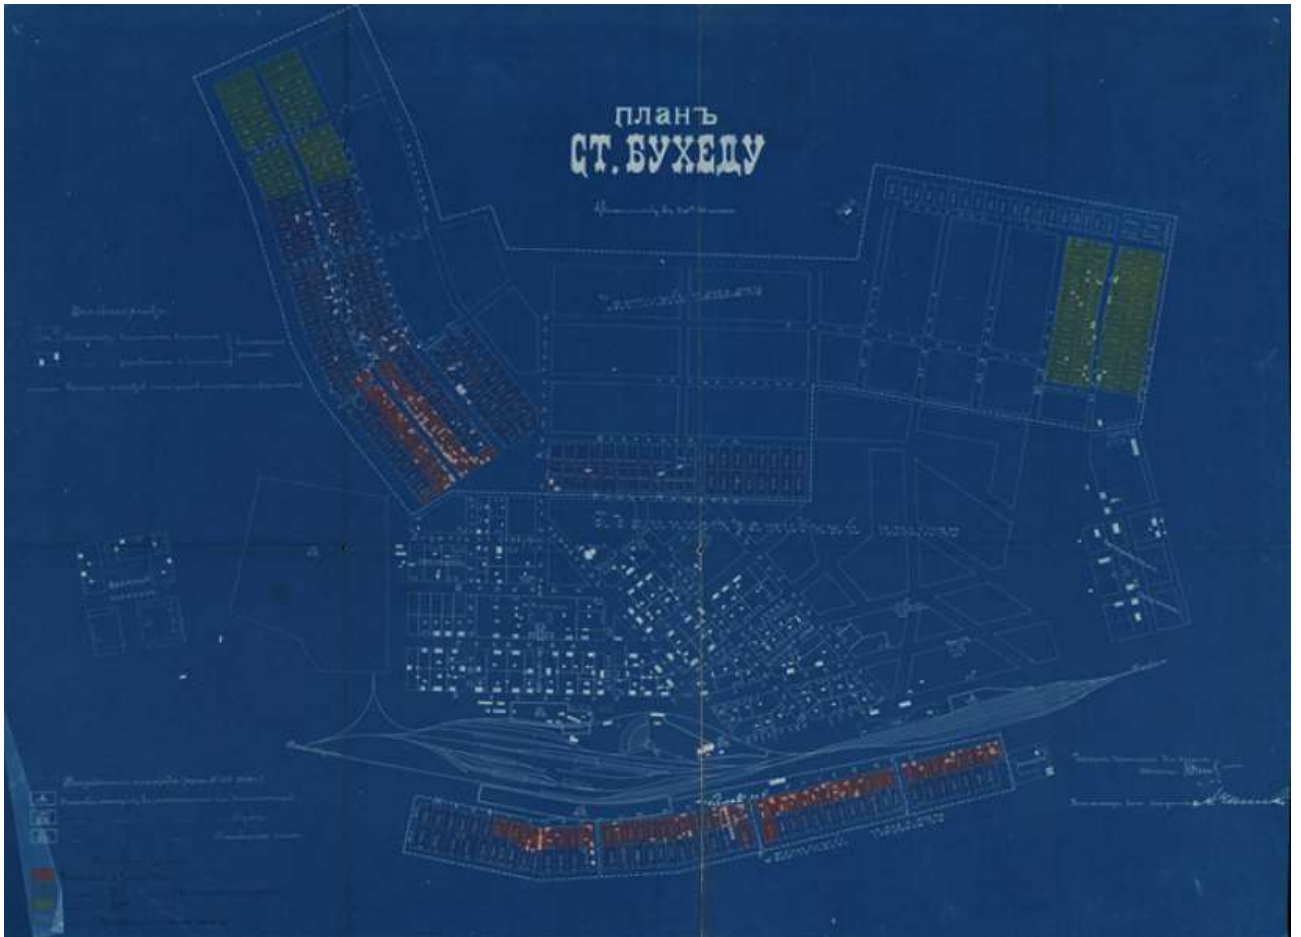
План расположения путей и зданий на станции Бухэду, план развития поселка (РГИА. Ф. 350. Оп. 16. Д. 637. Л. 12)
